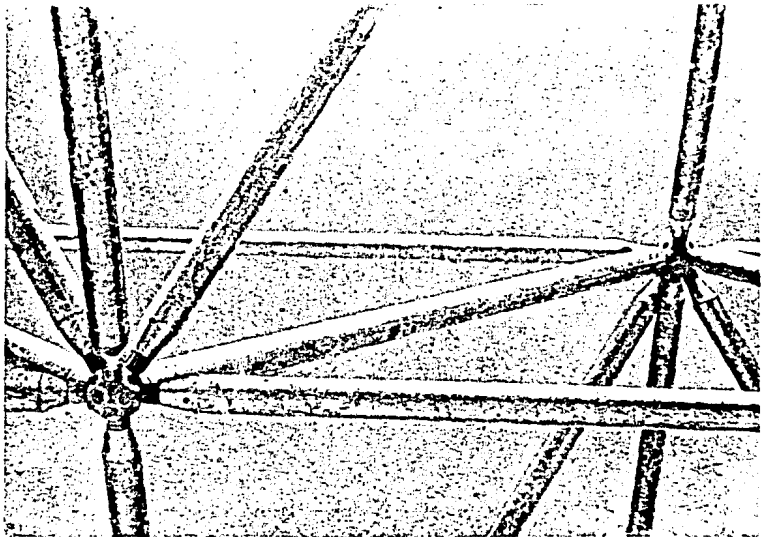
SISTEMA "MERO"; PERMITE UNIR HASTA 18 BARRAS ADEMÁS
